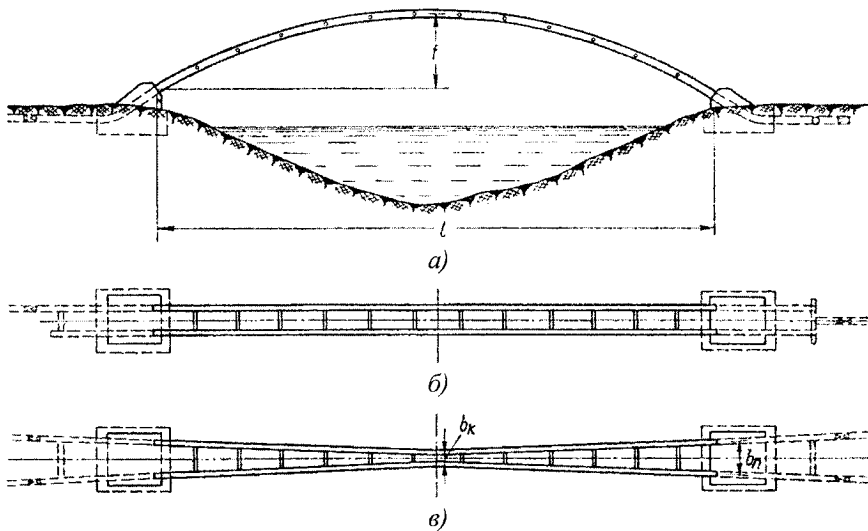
Аркові переходи з двох зв'язаних між собою робочих трубопроводів: а – профіль переходу; б – план при паралельних трубопроводах; в – план трубопроводів, що розходяться до п'ят
